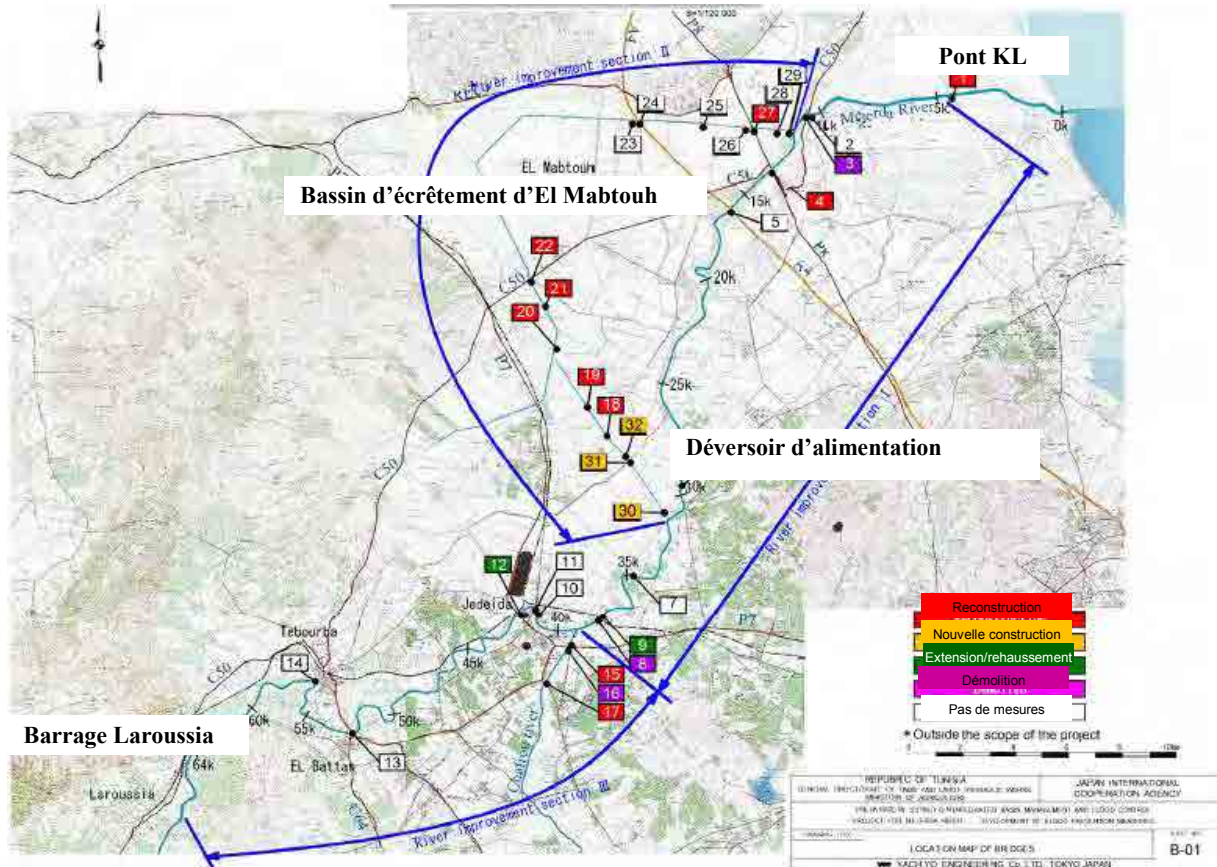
Zone de mise en œuvre du projet d'amélioration de l'oued et du projet du bassin de retardement (sections des travaux et emplacement des ponts et ouvrages de franchissement)
